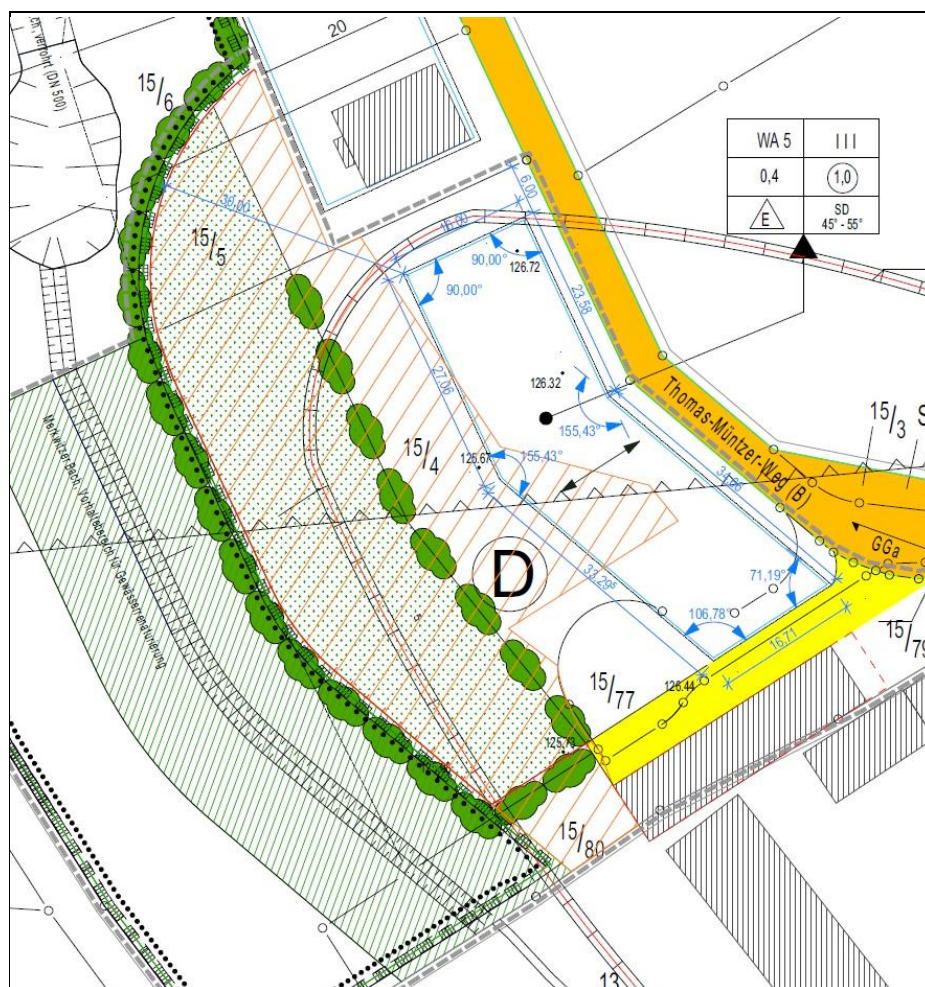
Lageplan Änderungsentwurf Geltungsbereich WA 5. Das Baufeld ist blau umrissen, die Fläche für die Waldumwandlung (= Betrachtungsraum des vorliegenden Gutachtens) ist braun schraffiert. (Quelle: wandererarchitektenBDA, Stand 26.11.2021, Ausschnitt)
